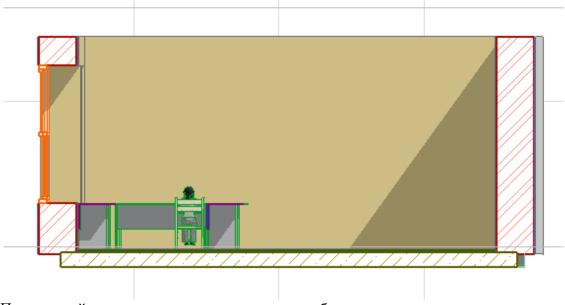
Поперечный разрез помещения с указанием рабочего места относительно оконных проемов
